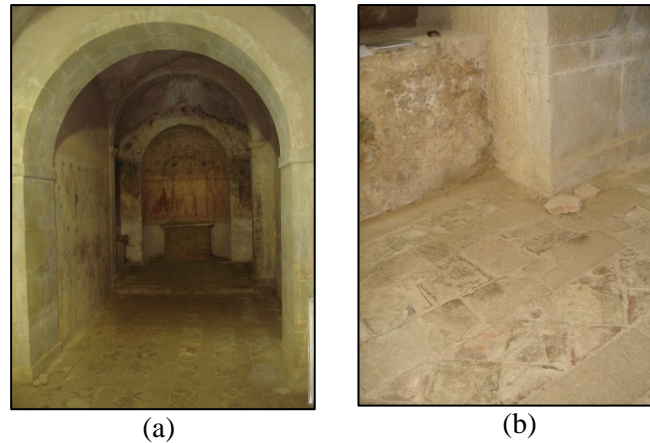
Navata unica della Chiesa (a); pavimentazione (b).
